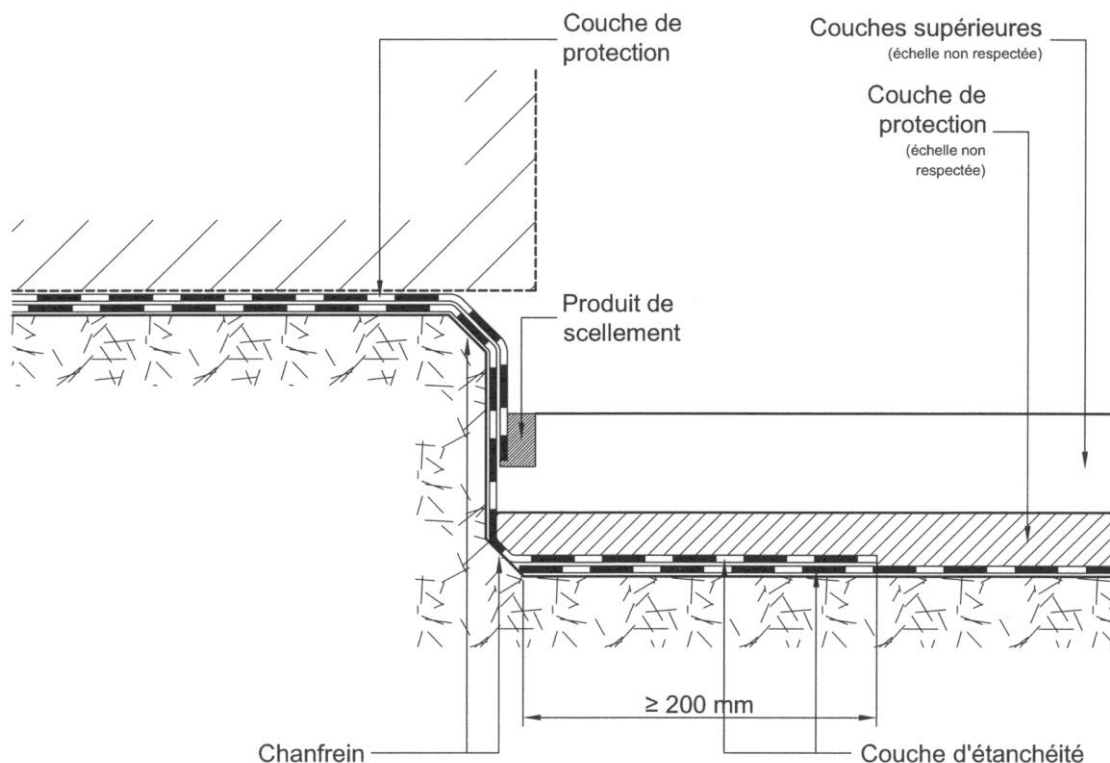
a. Traitement d'une discontinuité de niveau par feuille préfabriquée (étanchéité continue)
